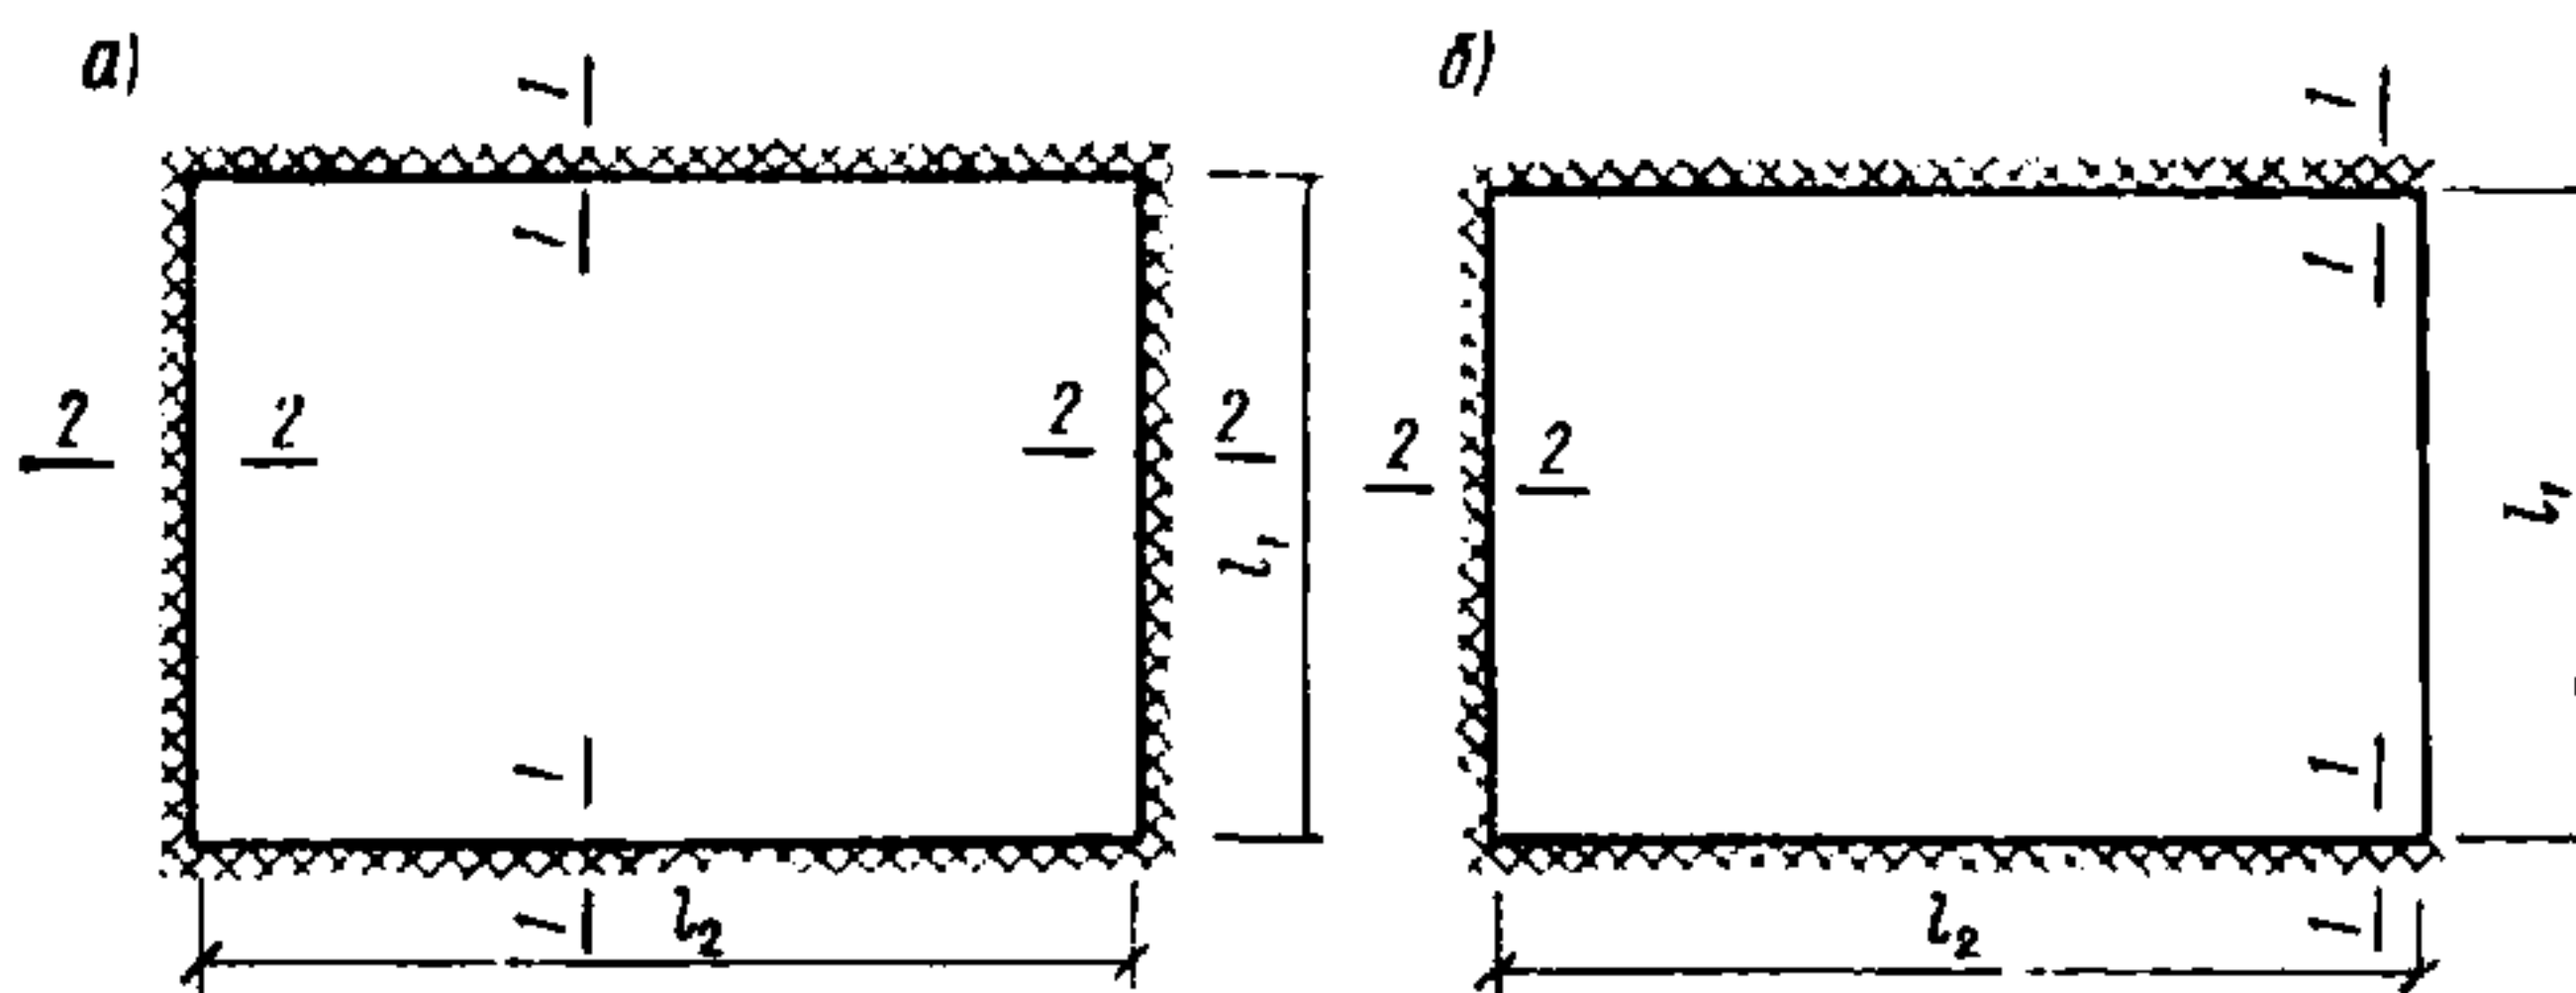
Расчетные сечения при определении нагрузки образования трещин на опорах в плитах перекрытий, защемленных по контуру (а) и по трем сторонам (б)
